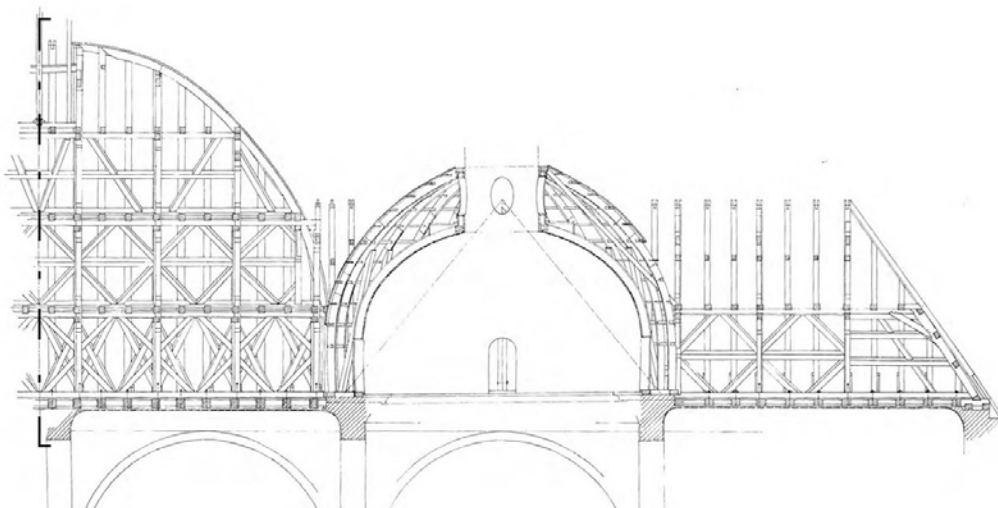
Längsschnitt Dachwerk über dem Langhaus der Pfarrkirche St. Mang in Füssen mit Markierung der Querschnittführung
